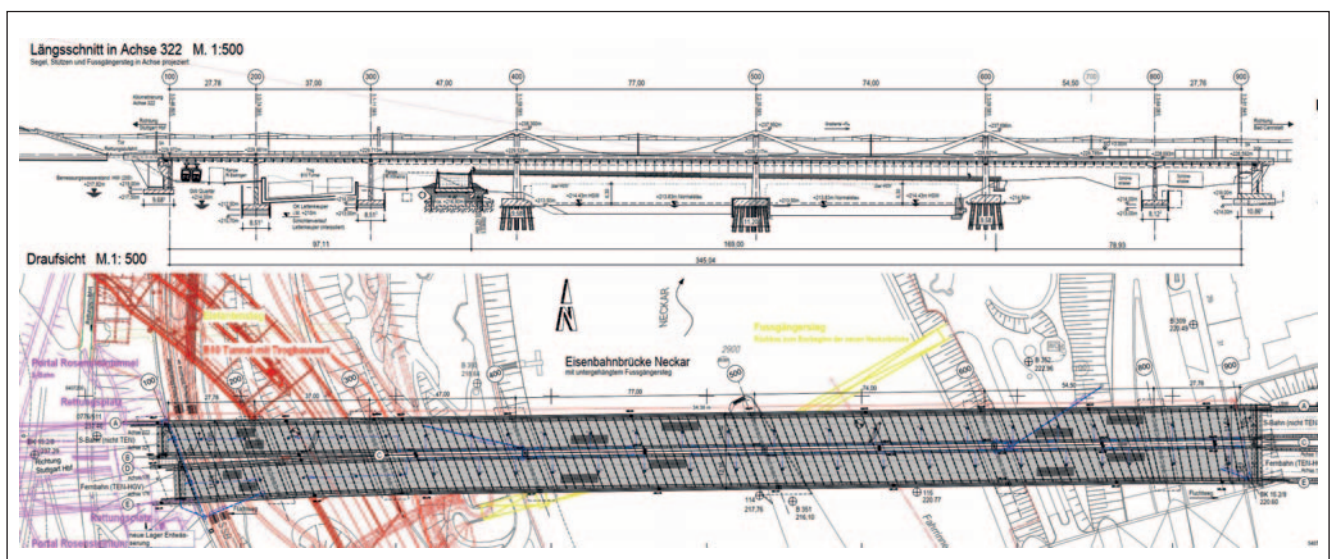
Planansatz Längsschnitt und Grundriss
